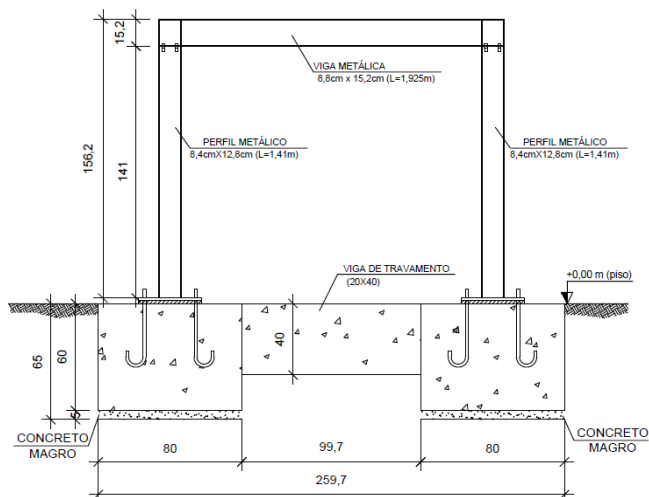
Corte esquemático do pórtico metálico e sua fundação (medidas em cm).
